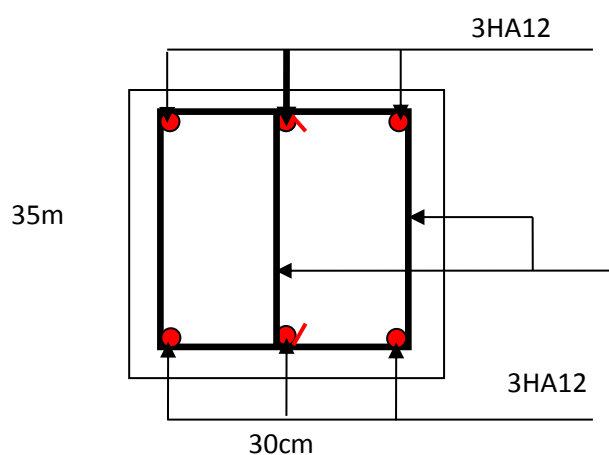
Schéma de ferrailage de la poutre de chaînage
